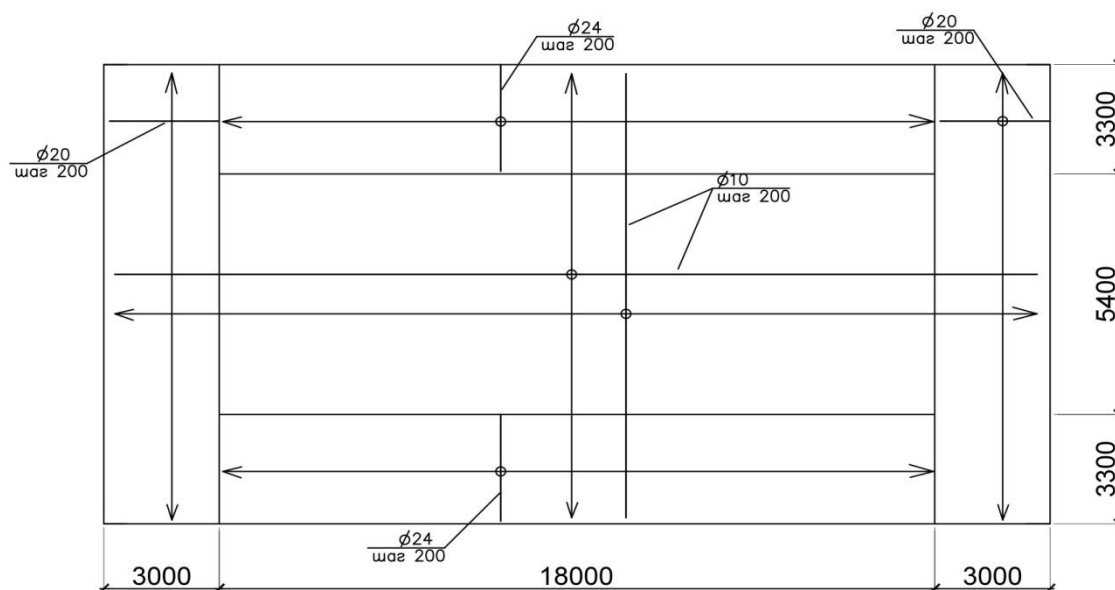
Армирование железобетонной плиты пролетного строения до усиления
